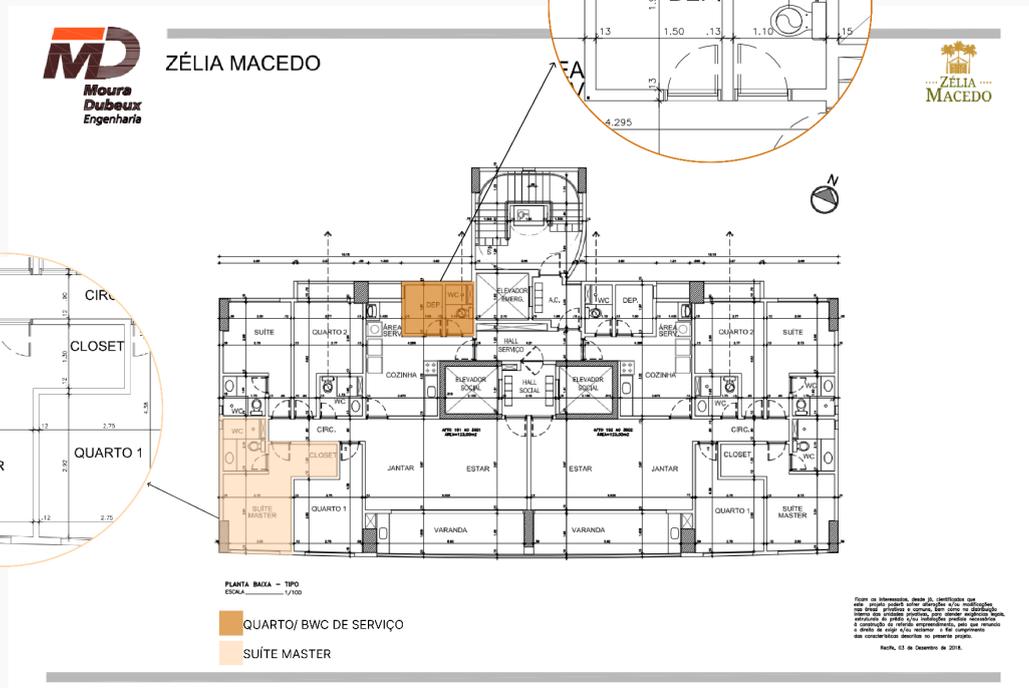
Planta Baixa Edifício Zélia Macedo.
